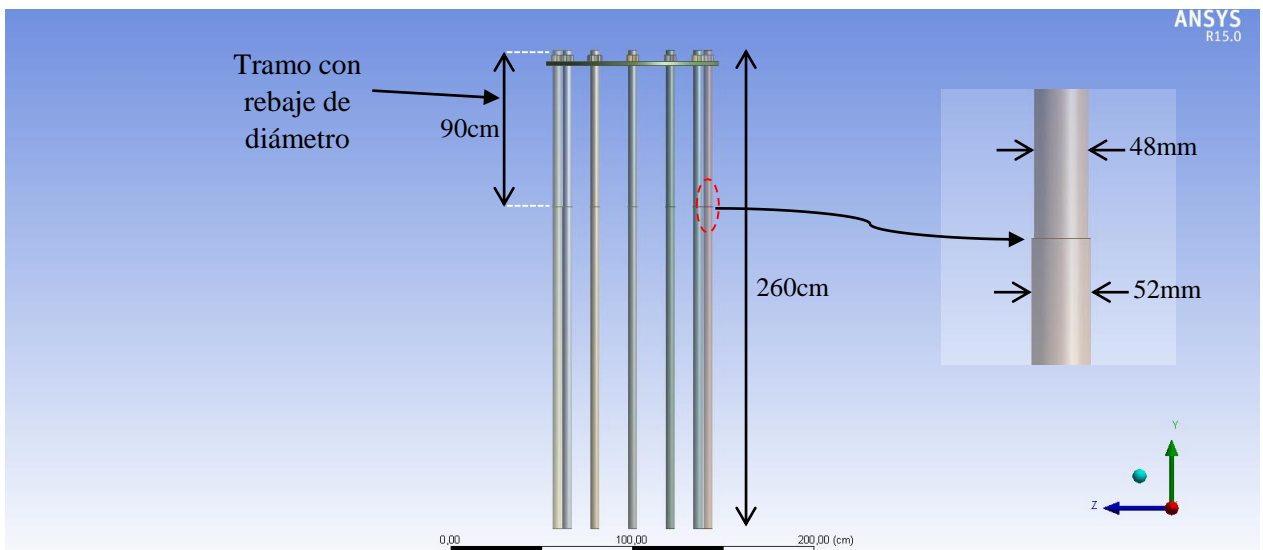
Detalle de las barras de anclaje (vista lateral).
